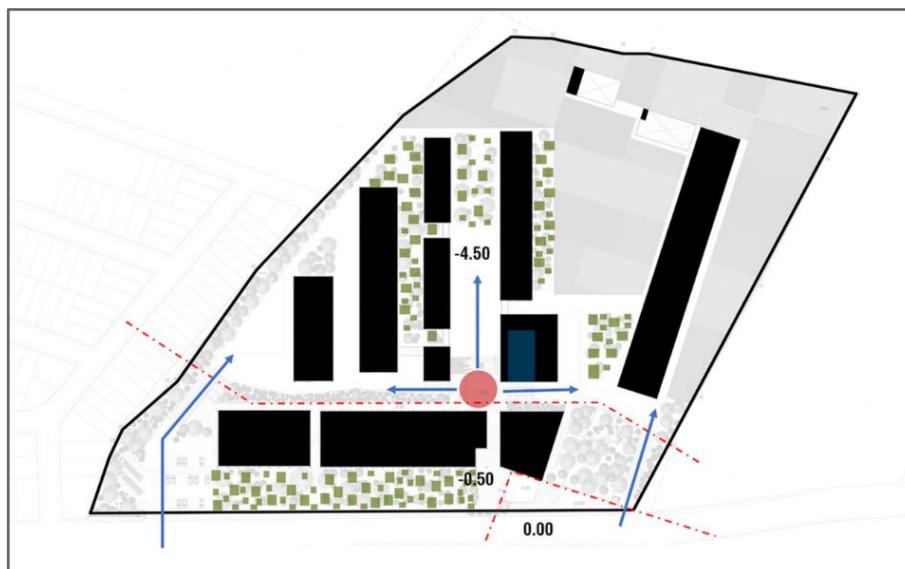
Planteamiento arquitectónico del proyecto
